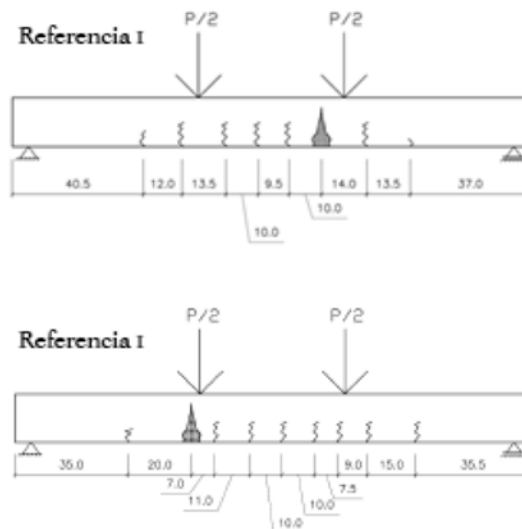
Agrietamiento de las vigas 1 y 2 de referencia, medido en centímetros
